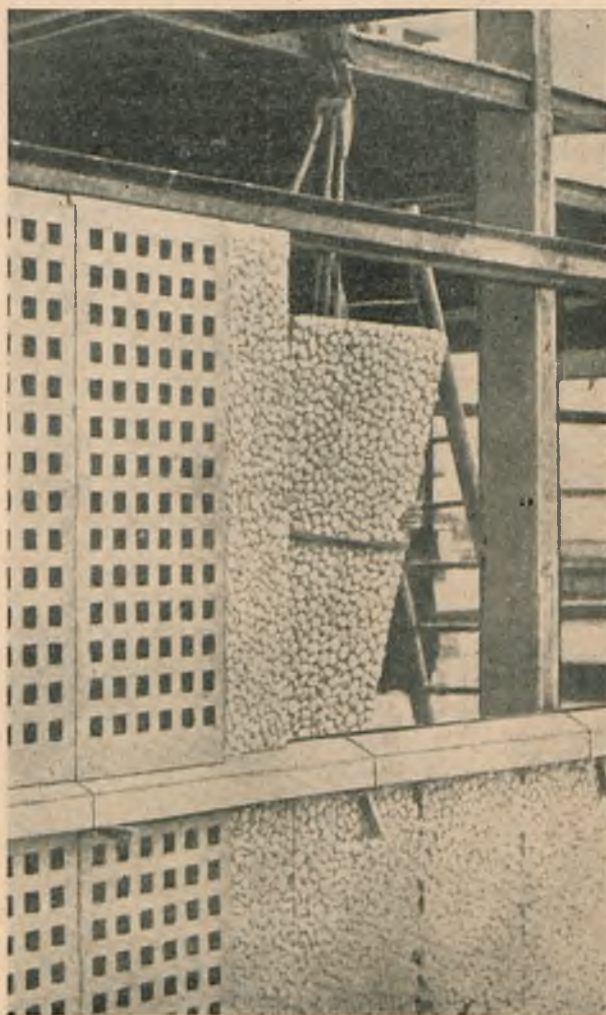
Montaż murów zewnętrznych domu wielopiętrowego składanego z gotowych elementów wg systemu E. M. w kolonii robotniczej Drancy pod Paryżem.
